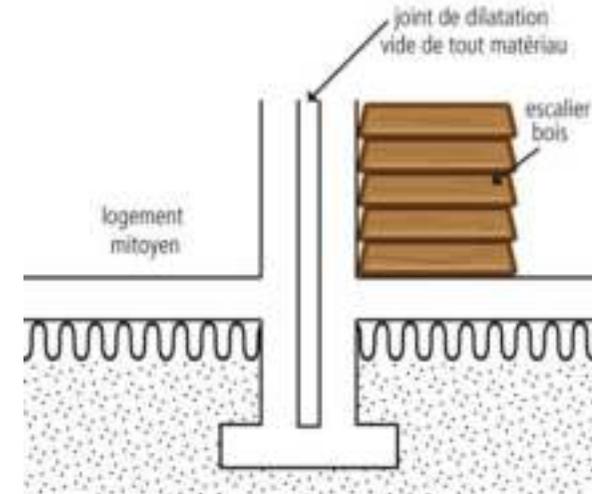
Escalier bois situé sur un plancher non filant vers le logement contigu
